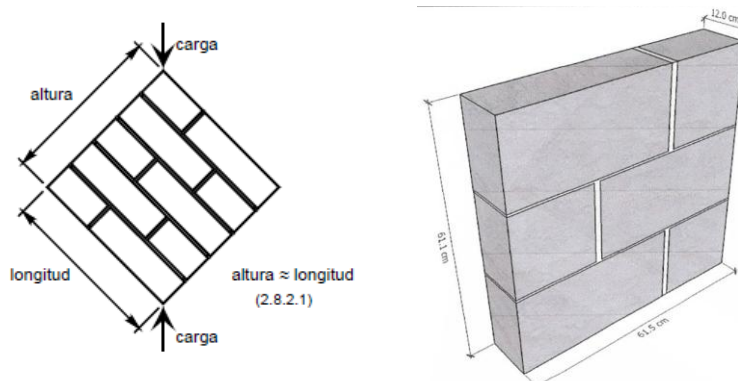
Murete de mampostería para prueba a compresión diagonal (el murete con dimensiones pertenece a una prueba realizada a unas piezas multiperforadas de Block de Concreto tipo “BH8 IBMEX”).^{3, 8}
